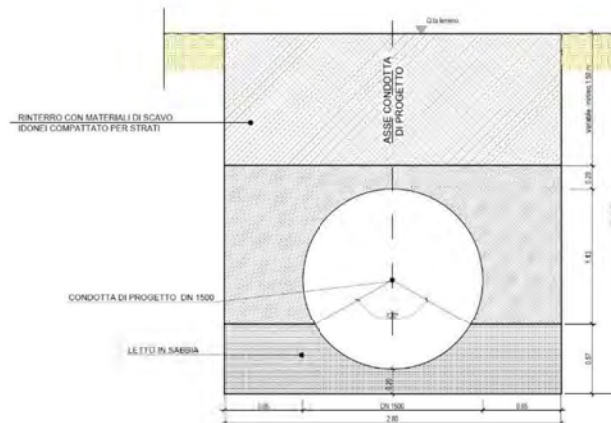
Sezione di posa in trincea stretta DN 1500 – Condotta adduttrice all'asta principale dell'acquedotto campano
